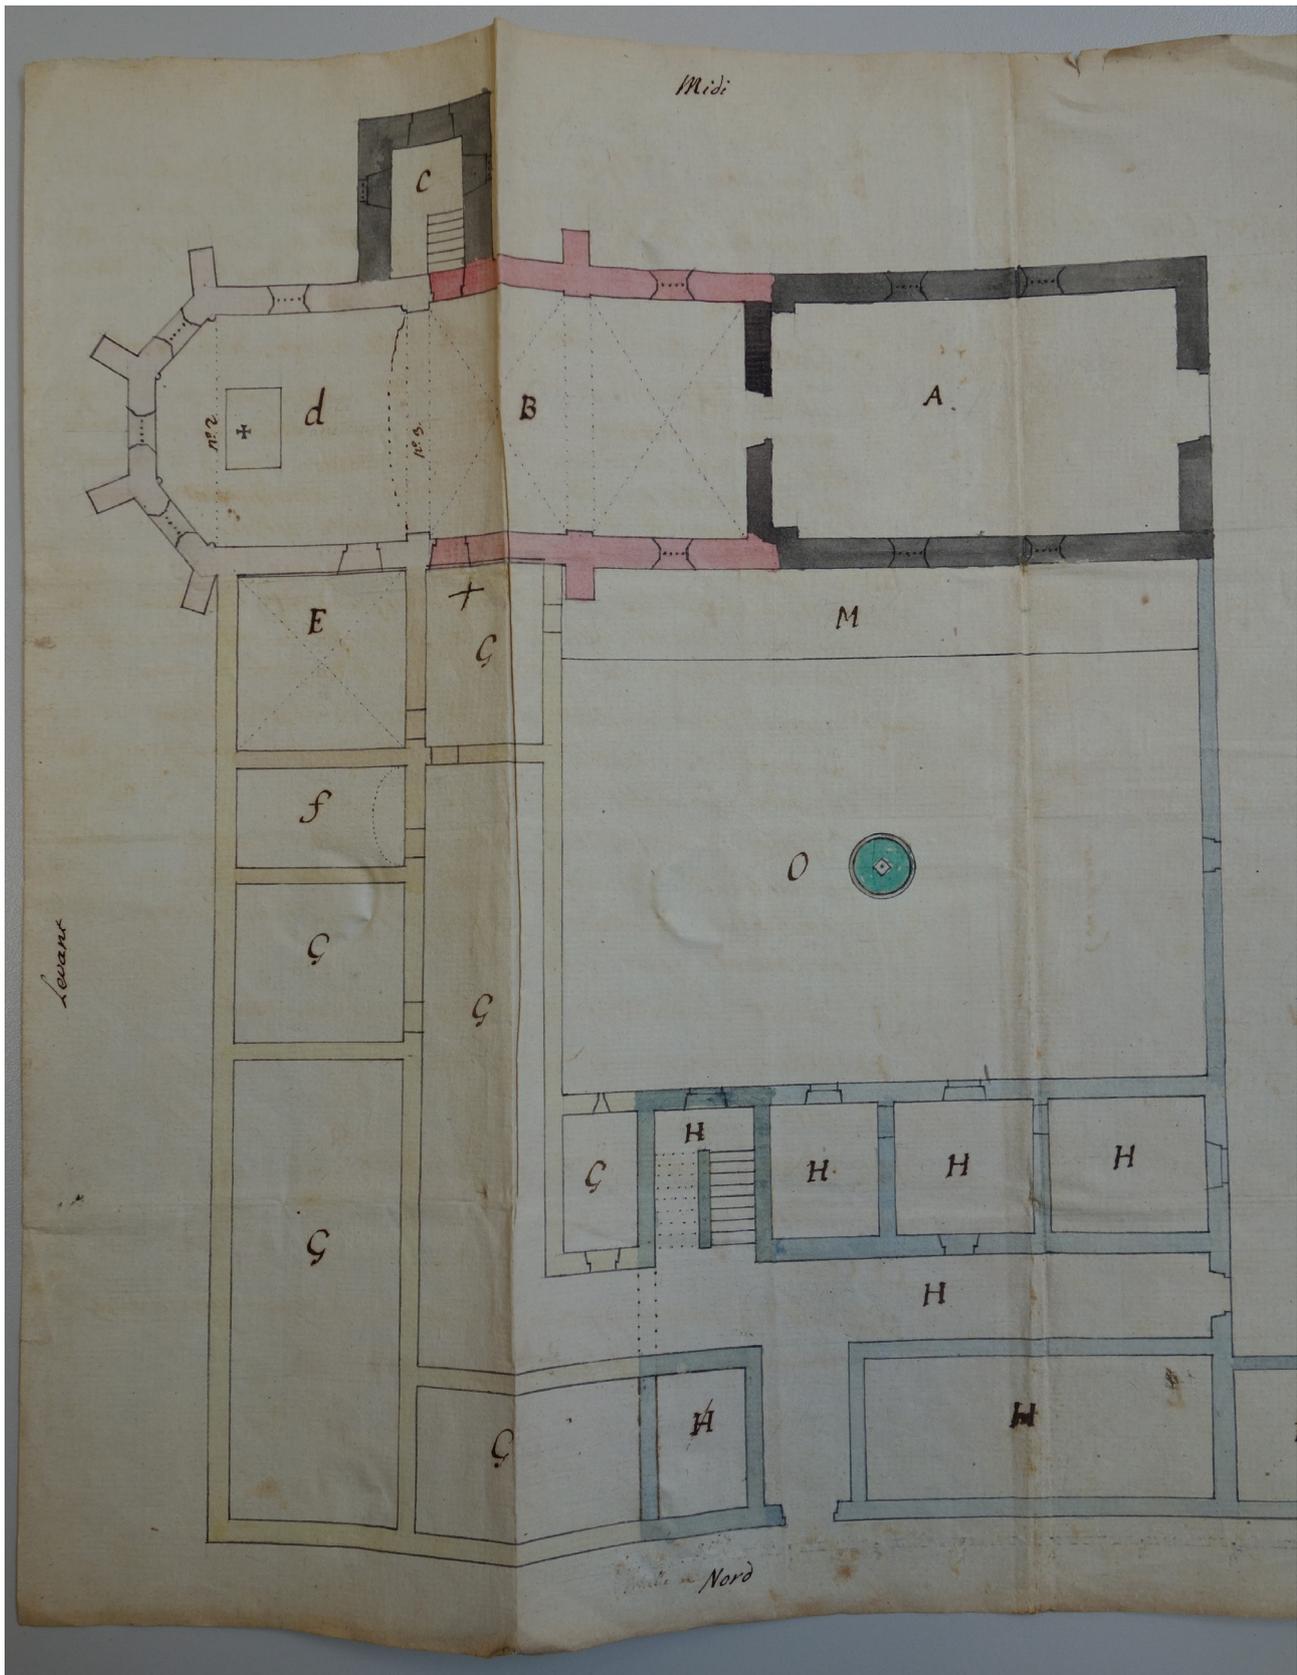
«Plan figuratif», Amoudruz Architecte, premier semestre 1770.
